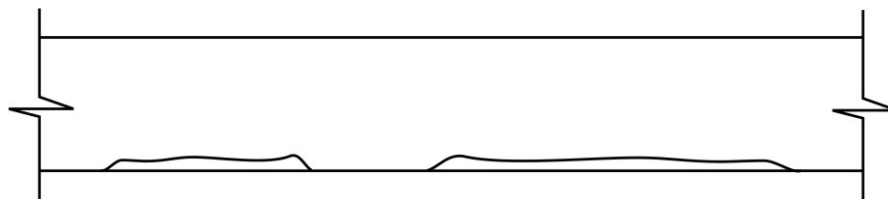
Típica forma de fissuras e lascamento em viga de concreto, paralela às armaduras inferiores. Geralmente estas fissuras são acompanhadas pelo destacamento da camada de proteção (HELENE, 1993)
